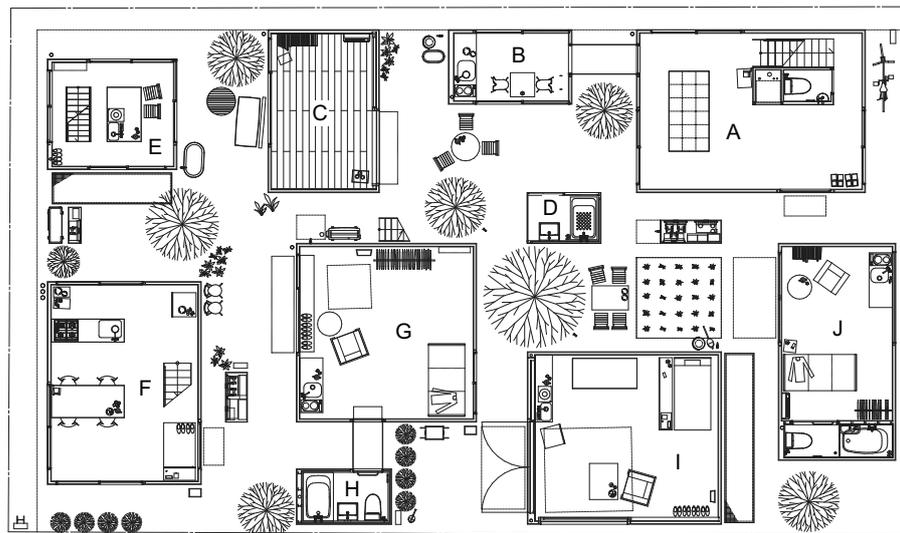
Grundriss Erdgeschoss und Zwischenräume
